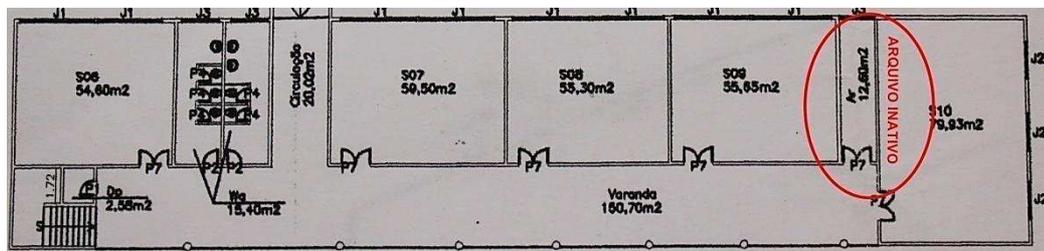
Planta baixa do Pavilhão Ernesto Simões Filho (térreo)
